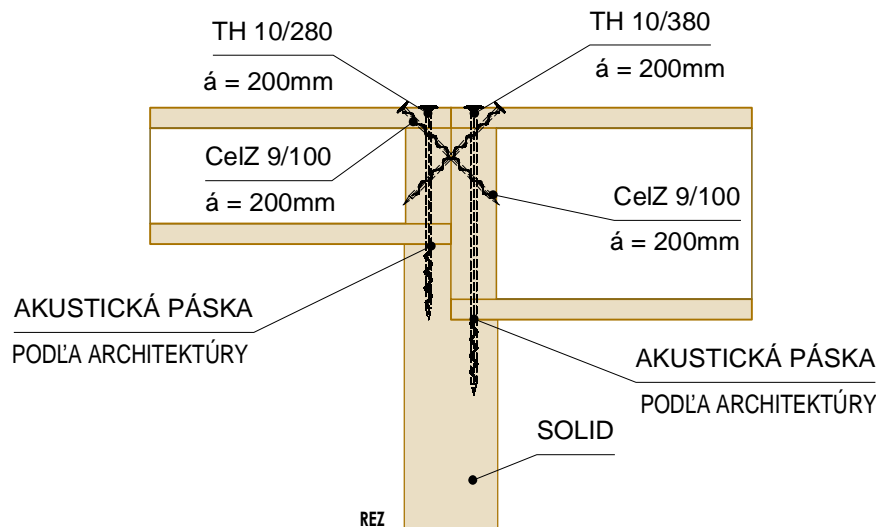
DETAIL "E" - PRIPOJENIE STROPNÉHO PANELU OPEN A OBVODOVEJ STENY
